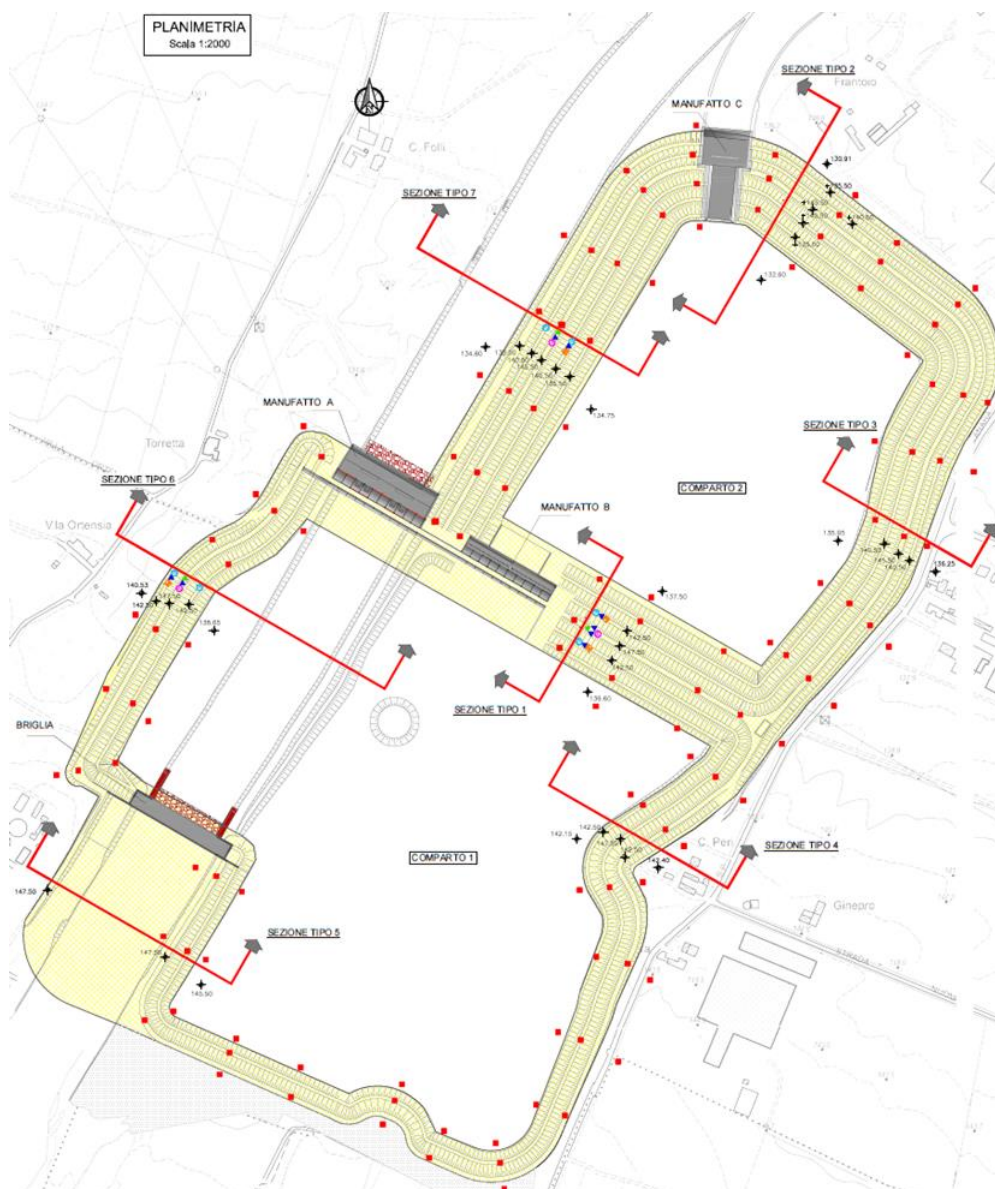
Planimetria con ubicazione sezioni di monitoraggio
